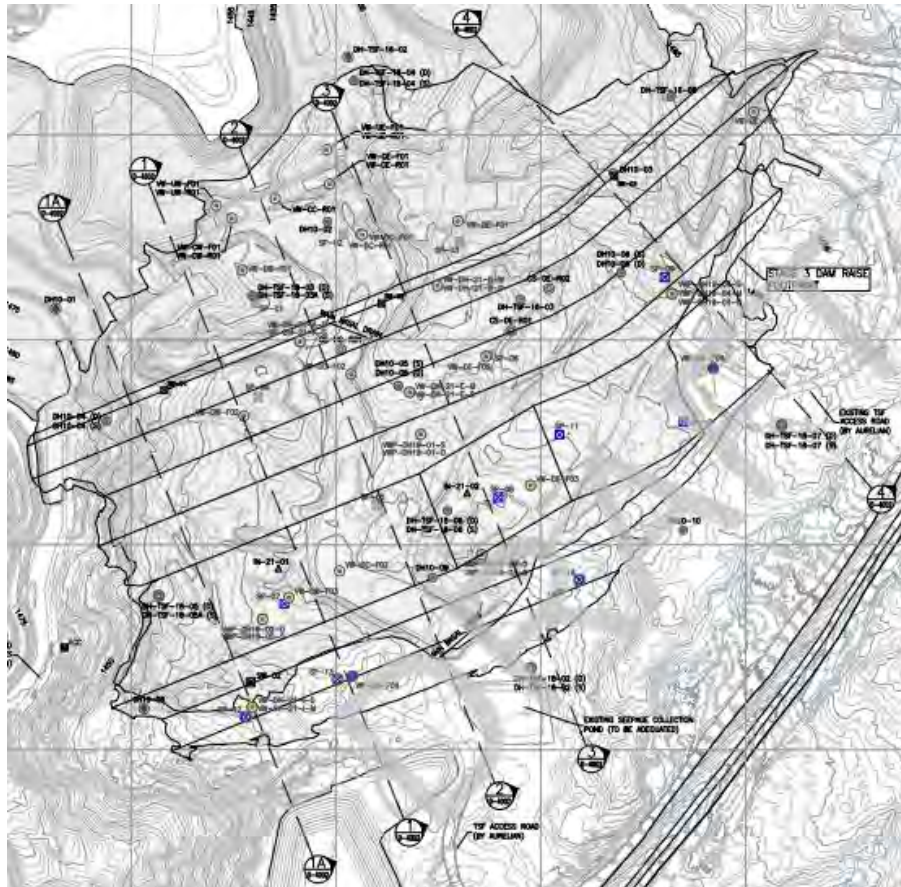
Plano de La Presa con la instrumentación instalada (R. Robles, 2022)
